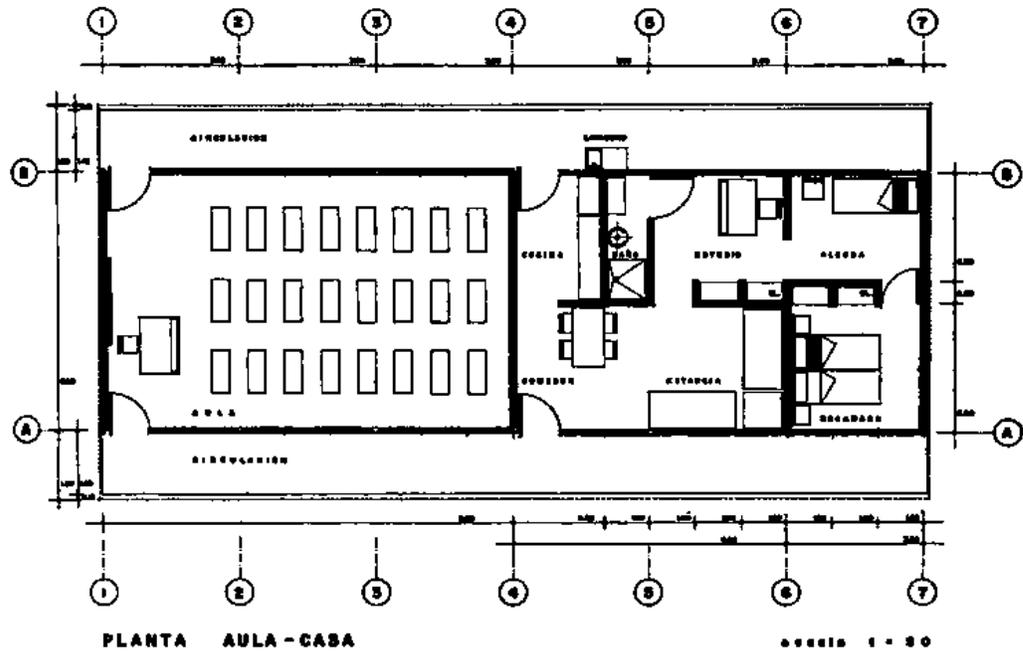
Planta. Aula Casa Rural, Pedro Ramírez Vázquez, 1959.
